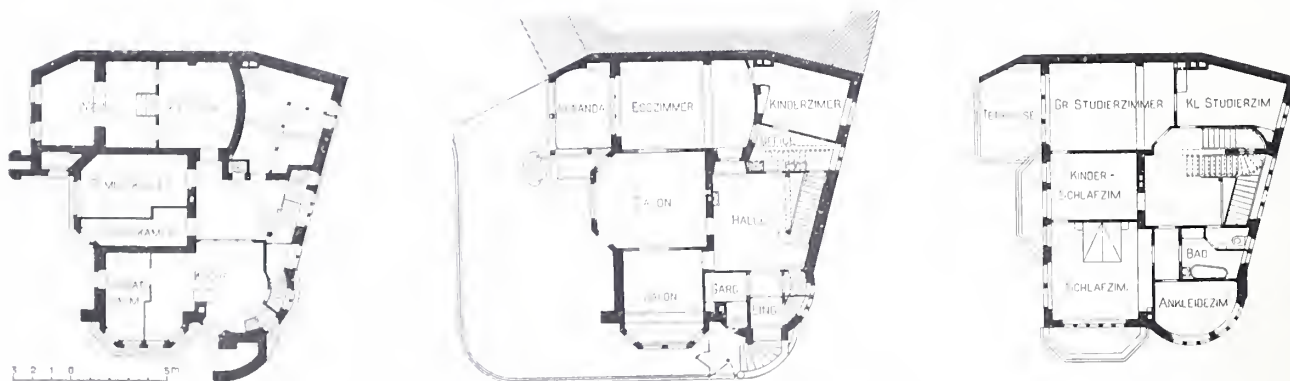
, 4, 5. Grundrisse vom Kellergeschoss, Erdgeschoss und ersten Stock des Hauses Ecke Nonnenweg und Pilgerstrasse.
